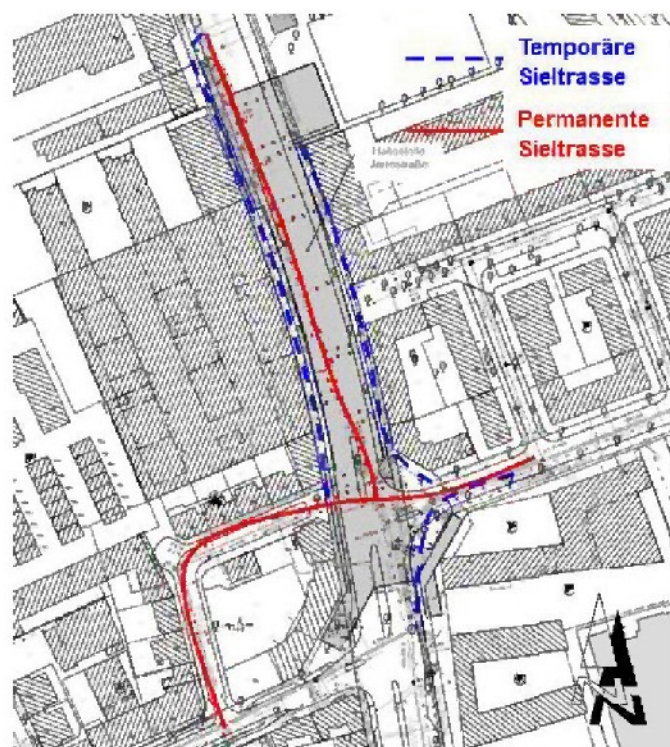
Sielverlegung an der Haltestelle. Jarrestraße
